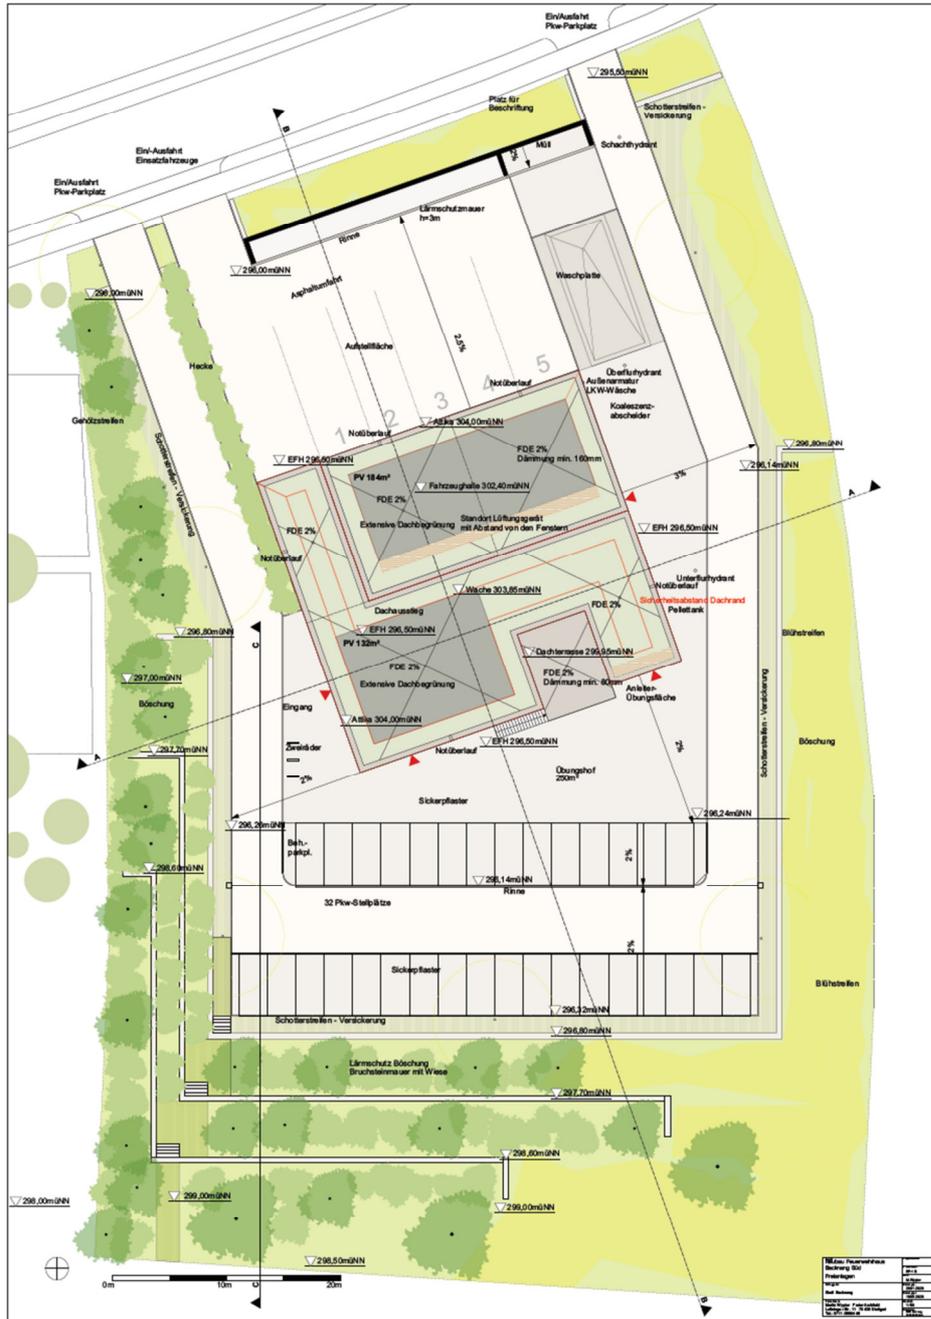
Lageplan Dachaufsicht Feuerwehrhaus (Stand 18.05.2020), Wypior-Freier Architekt
